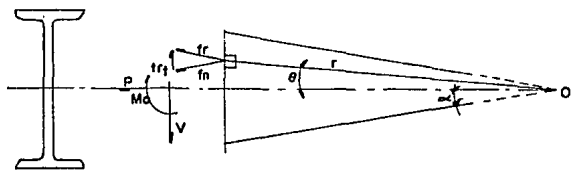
Esfuerzos en una viga acartelada de sección no rectangular.
